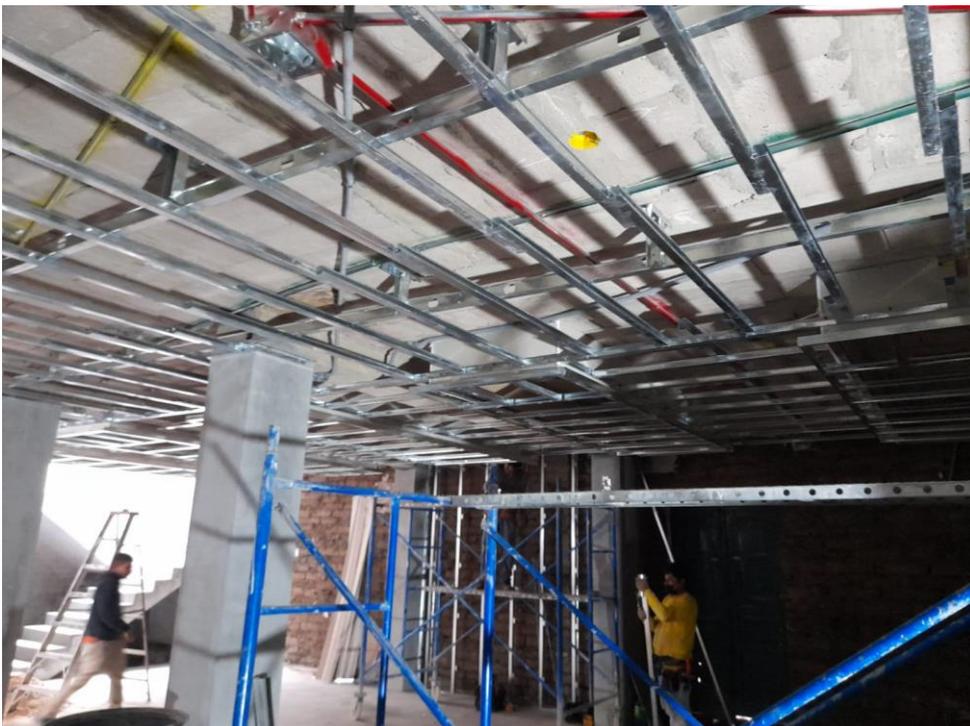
Proceso de construcción – instalaciones eléctricas en falso cielo raso en área de mesas.
